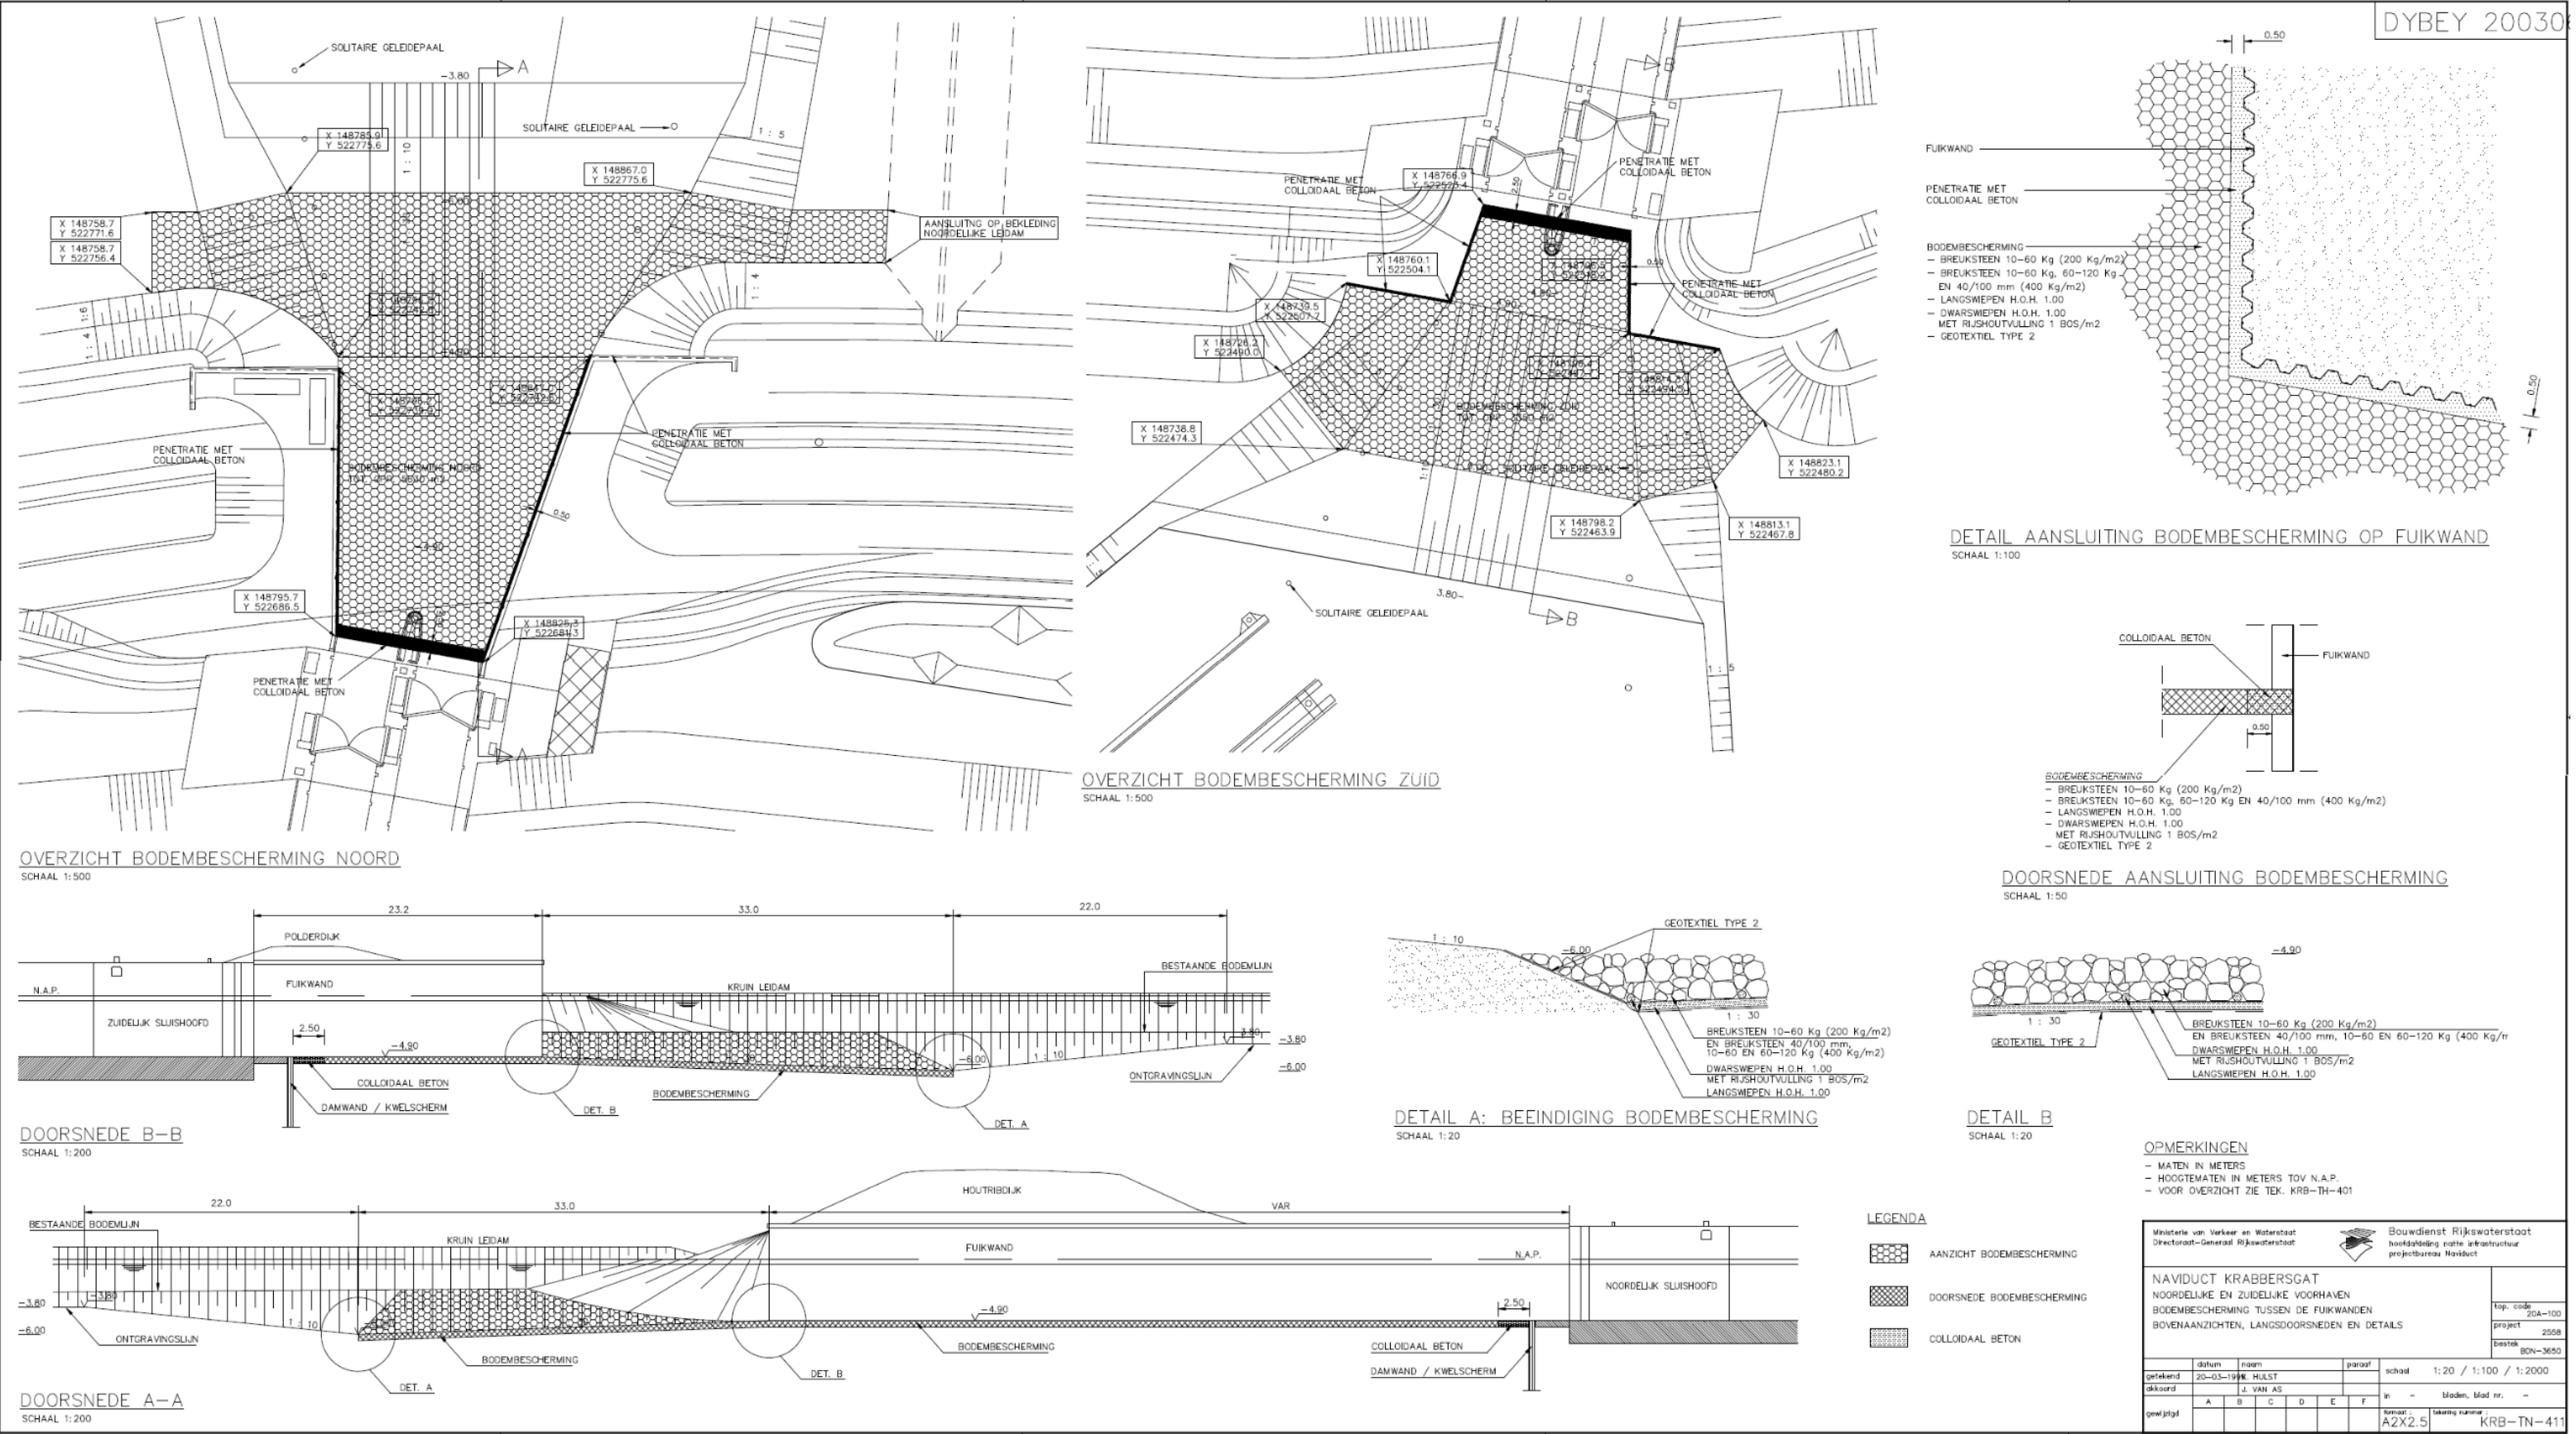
laat de overzichtstekeningen zien van de bodembescherming bij het Naviduct. Nabij het sluishoofd is een strook van 2,5 meter colloïdaal beton aangebracht, direct aansluitend op de constructie. Deze betonlaag vormt de overgang naar de bodembescherming die zich uitstrekt vanaf een diepte van NAP - 4,90 meter tot aan het einde van de fuikwanden. Vanaf dat punt helt de bodem met een flauwe helling van 1:30 af tot een diepte van NAP -6,00 meter.
